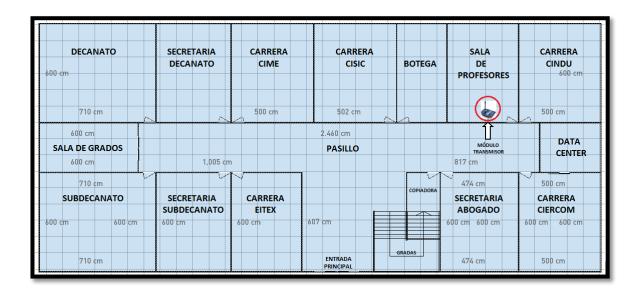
Planos de la planta baja de la facultad con el módulo transmisor.
